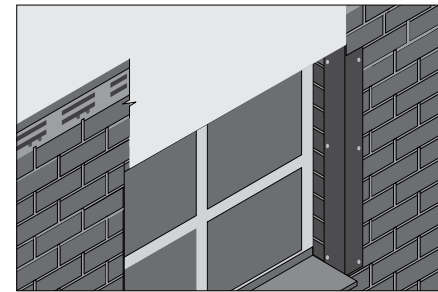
Монтаж бокового наличника (верхний край заходит под фасадную плитку)
